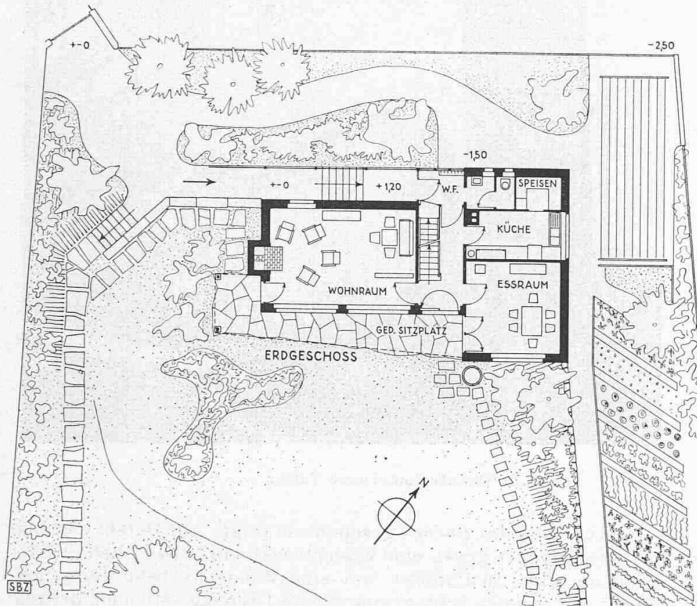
Haus St. in Wabern bei Bern, Grundrisse 1:400. — Arch. H. BRECHBÜHLER, Bern
